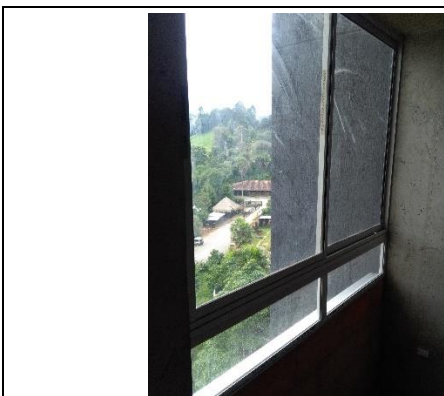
Terminación de mampostería e inicio de revocos en fachada.
